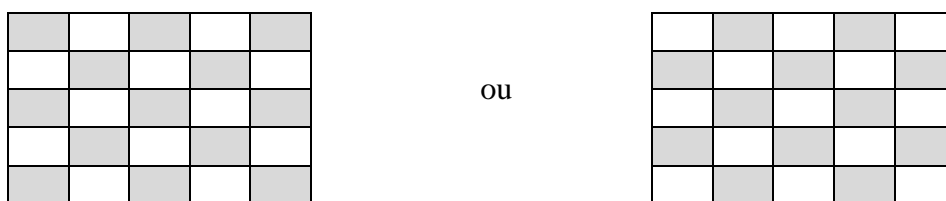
Chargements en damier d'une zone de dalle 5 travées × 5 travées
